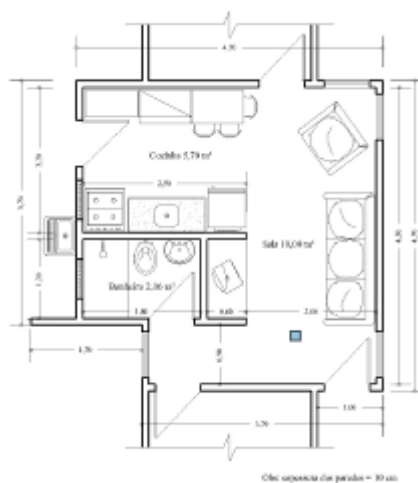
Plantas baixas das casas térreas CA7S-T e CA8-T do AUTOMET, com projeto mínimo - embrião (hachurado).
